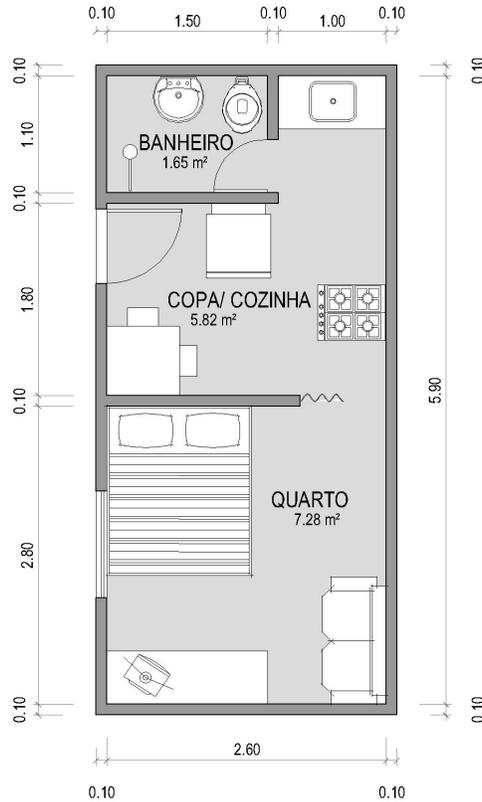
Planta baixa da casa da Sra. Janaina. Área: 14,75 m².
